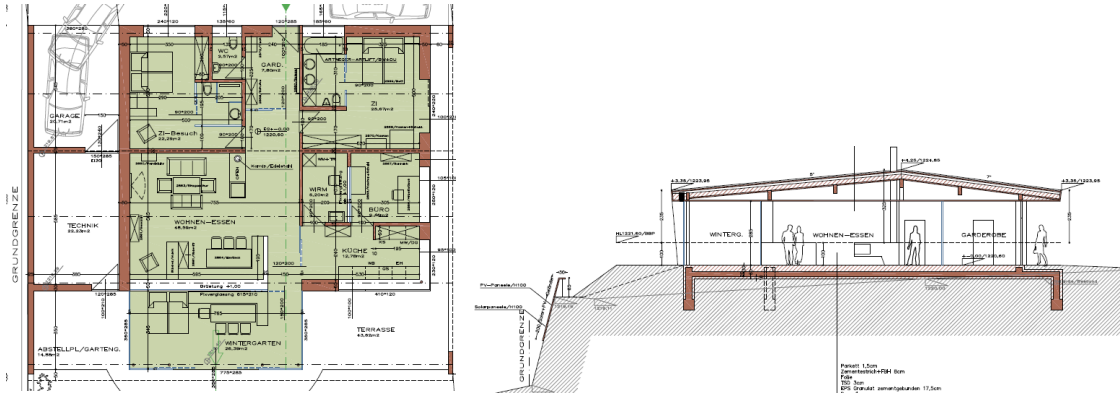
Grundriss (links) und Schnitt (rechts) des Solarhauses Felsch (Quelle: Einreichplan)
